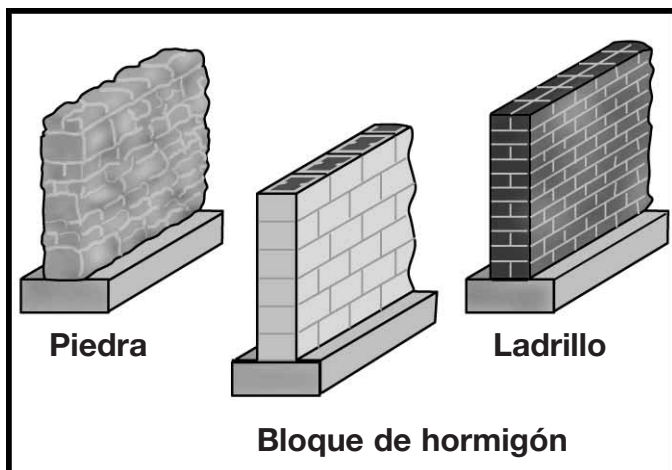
Los tipos principales de construcción de albañilería son piedra, productos de hormigón y ladrillos.
